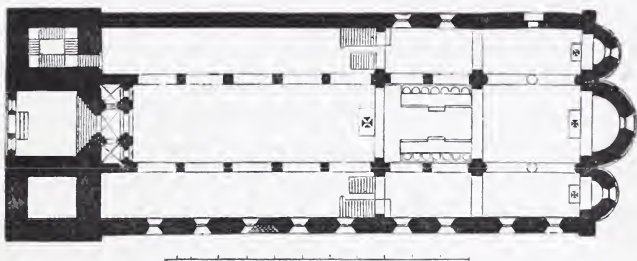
Grundriss des Domes zu Gurk.
